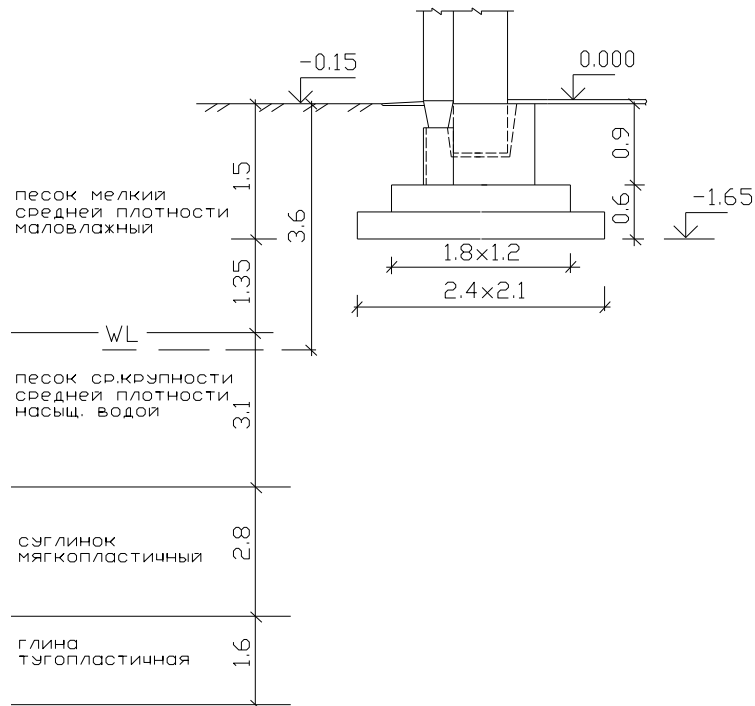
Сечение отдельно стоящего монолитного фундамента под колонну крайнего ряда
